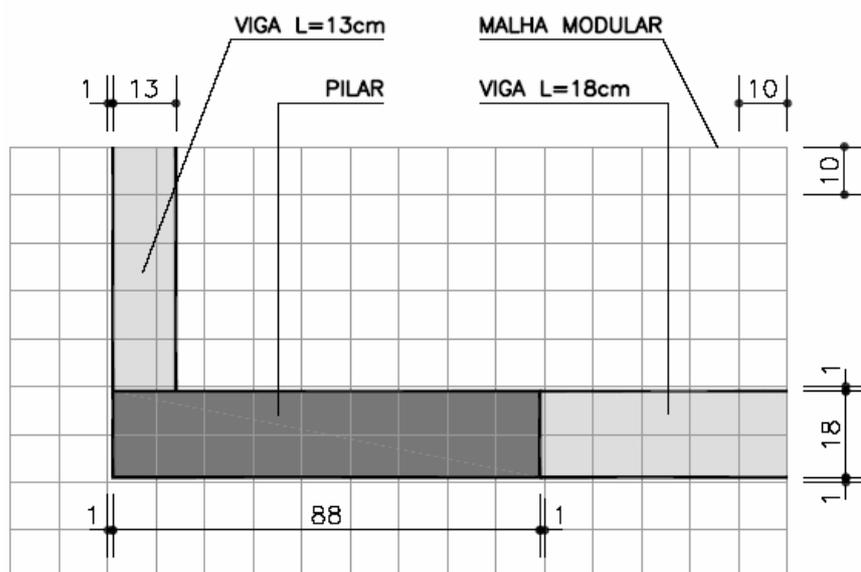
Localização de vigas e pilares na malha modular segundo Lucini
